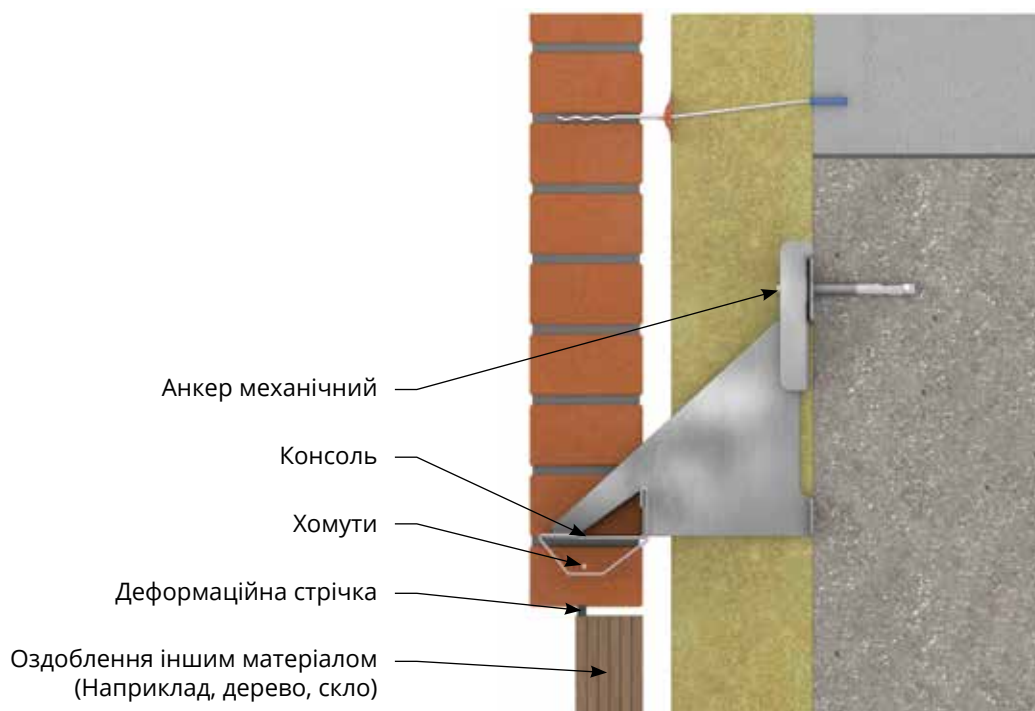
Зведення фасаду на висоті будівлі, версія 2
